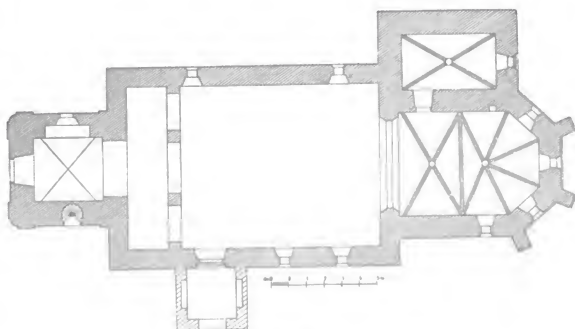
Mauth. Grundriss der Sct. Stephanskirche.
